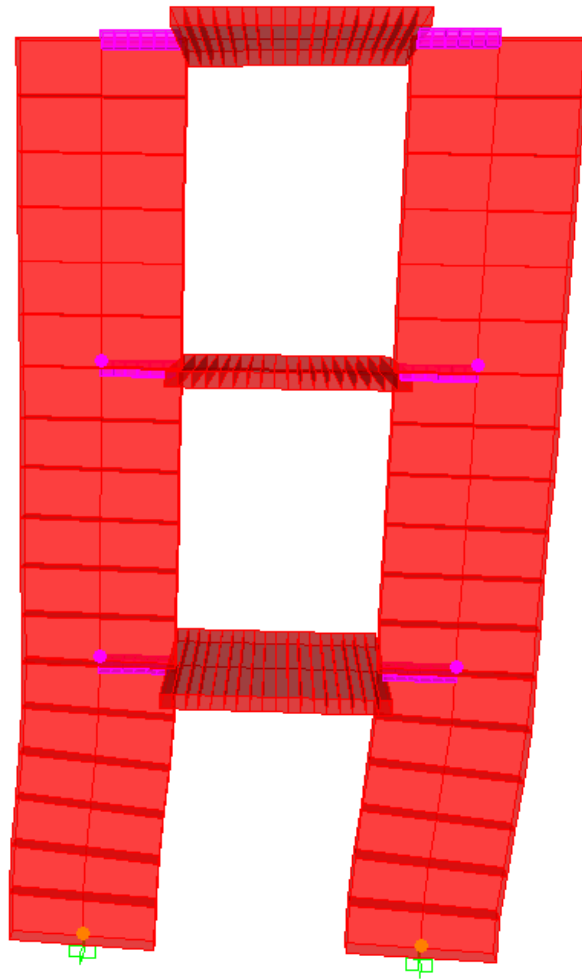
Perspectiva 3D, modelo columna ancha de “Muro 0”
